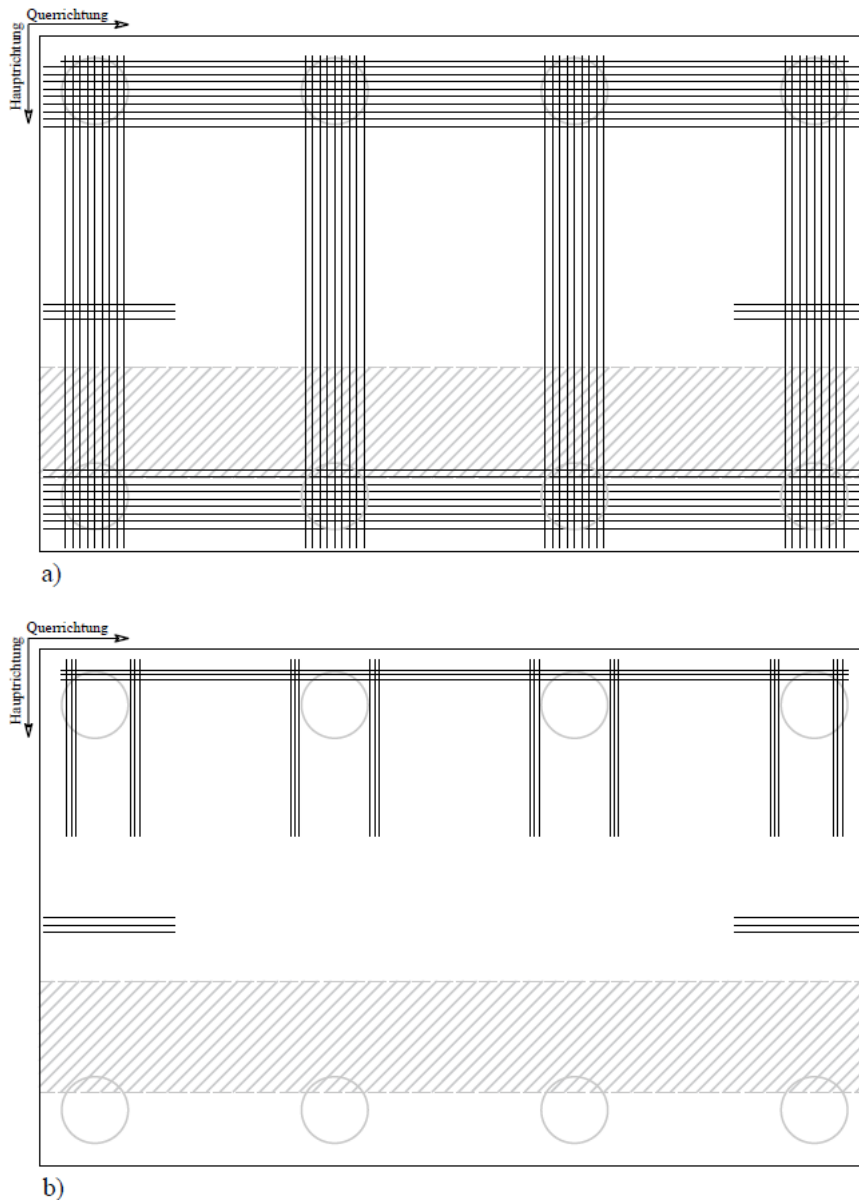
Variante 3 Lastfall 1 - a)Bewehrung unten, b)Bewehrung oben
